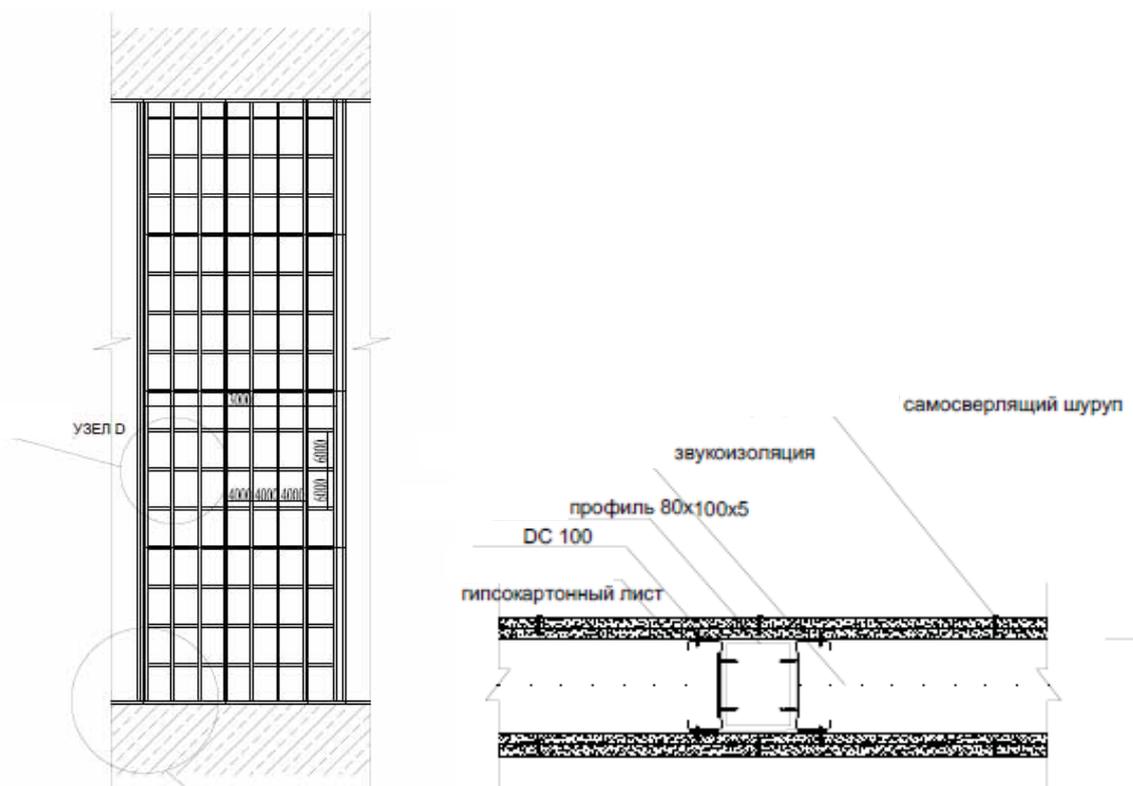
Схема и сечение внутреннего фасада (атриум) из гипсокартонной стены.
